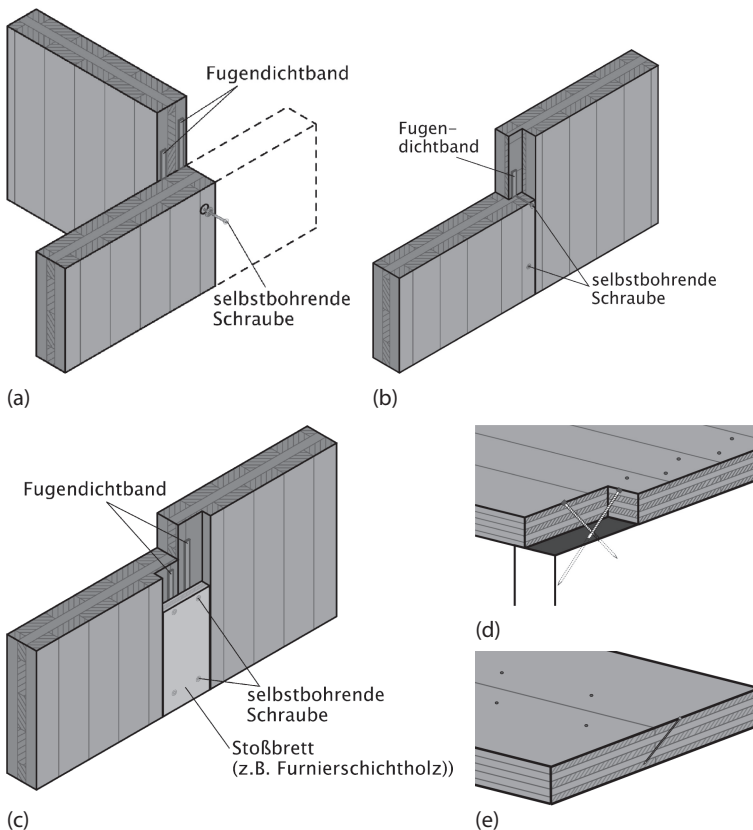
Elementstöße bei Brettsper Holzkonstruktionen: (a) Eckstoß/T-Stoß, (b) Elementstoß mit Überblattung, (c) Elementstoß mit Stoßbrett, (d) Anschluss Decke-Wand mit Schrägverschraubung und (e) Elementstoß mit Schrägverschraubung.
